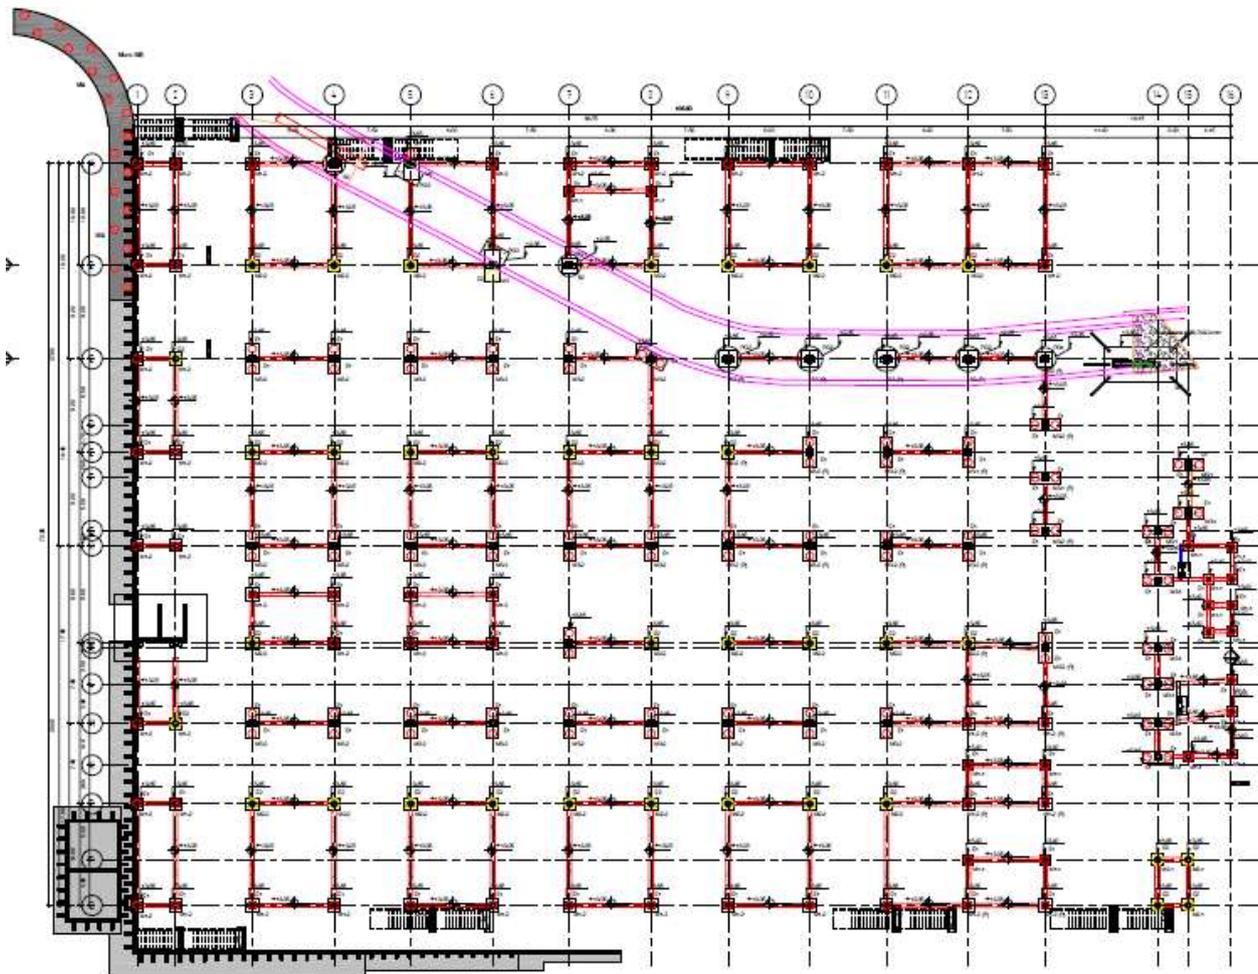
Planta de Implantação de Estacas - (Fonte: Projeto de Implantação de Estacas, 2019)
